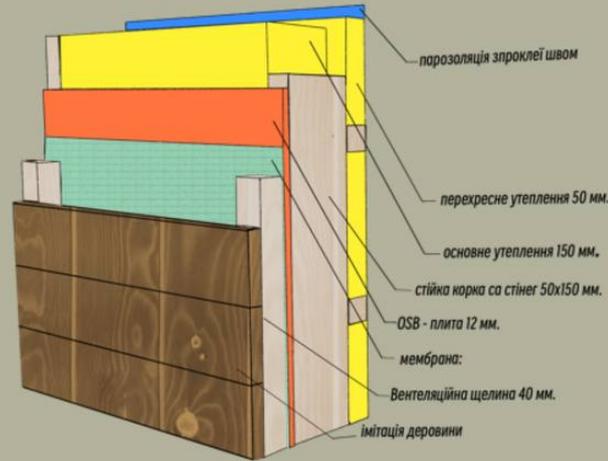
Фрагмент вентильованого фасаду
